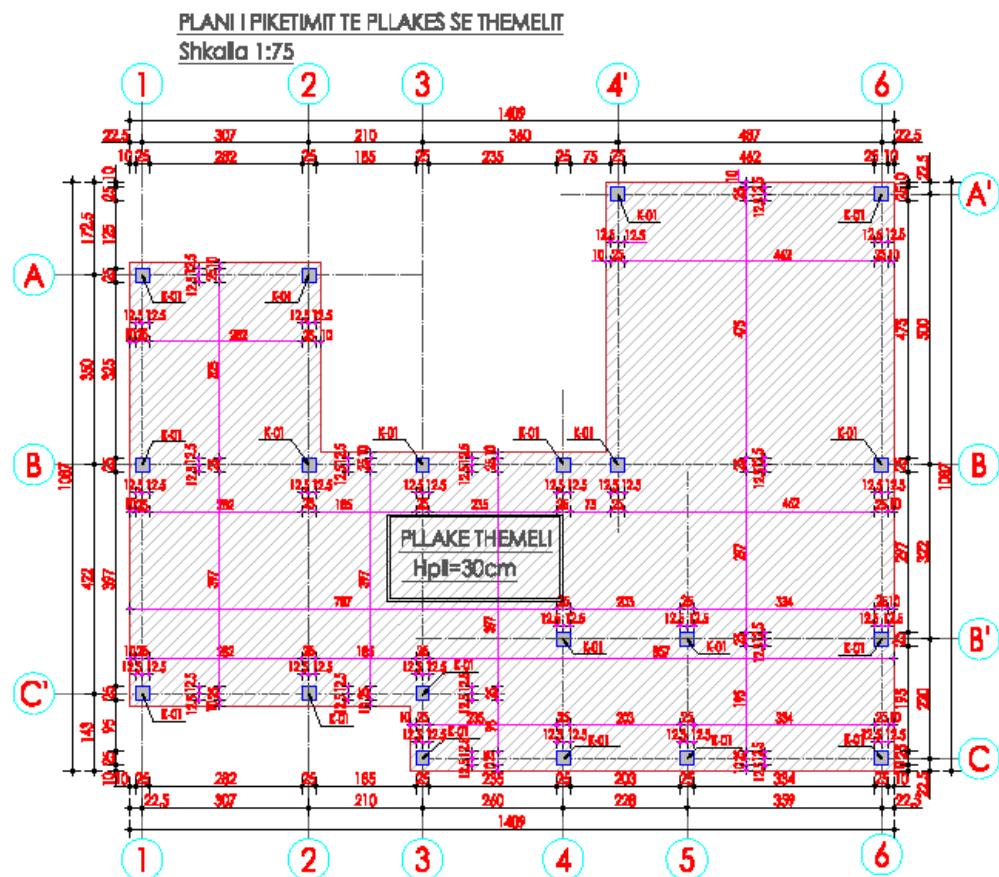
Plani i piketimit te pllakes b/arمه 30cm
